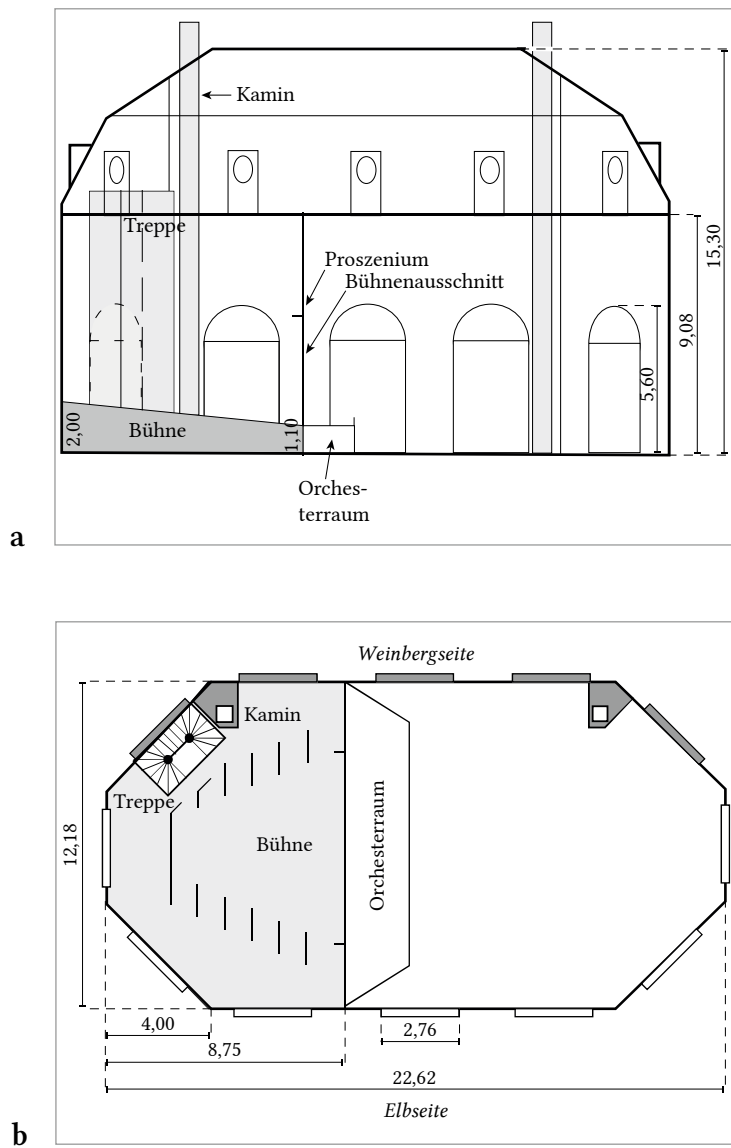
, b. Orangerie-Theater Pillnitz, Rekonstruktionsversuch, Längsschnitt und Grundriss (Zeichnungen des Verfassers).
